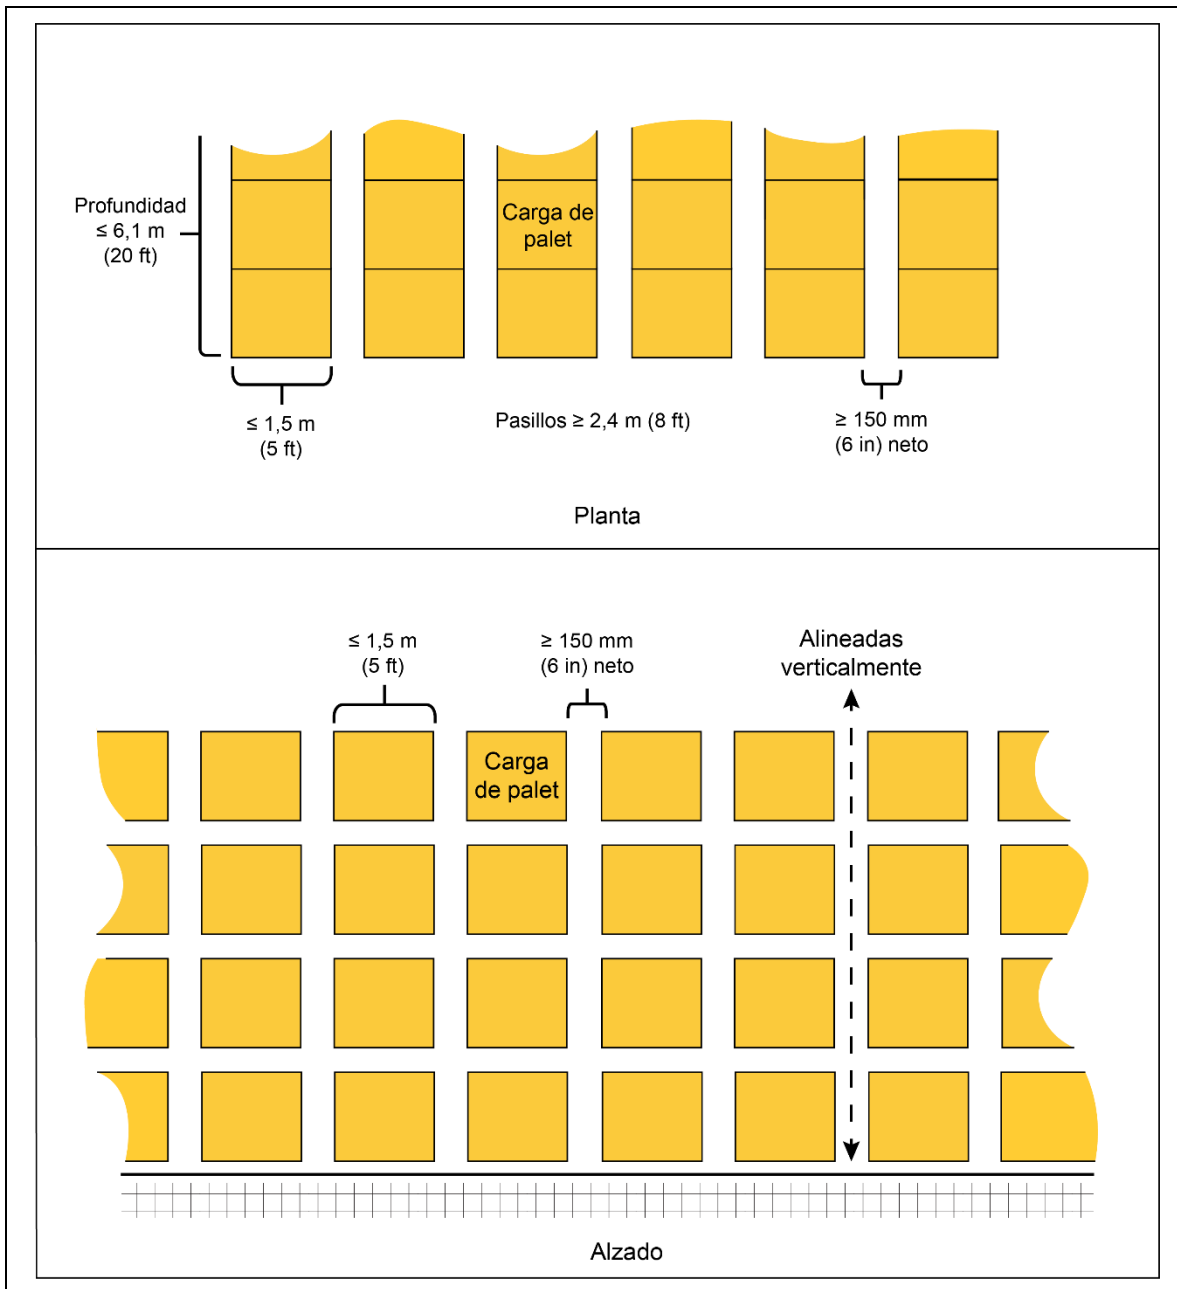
Configuración aceptable de las chimeneas transversales para estanterías múltiples abiertas, Opción 2
